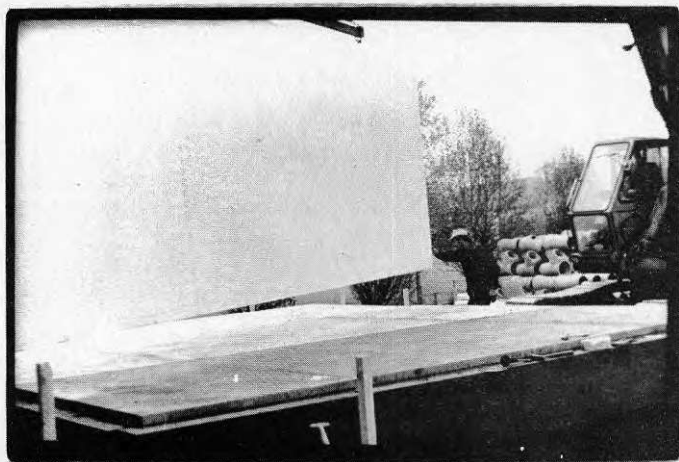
Kombinationen låg densitet och tunna betongdimensioner medför att 3L-betongelementen kan göras stora
